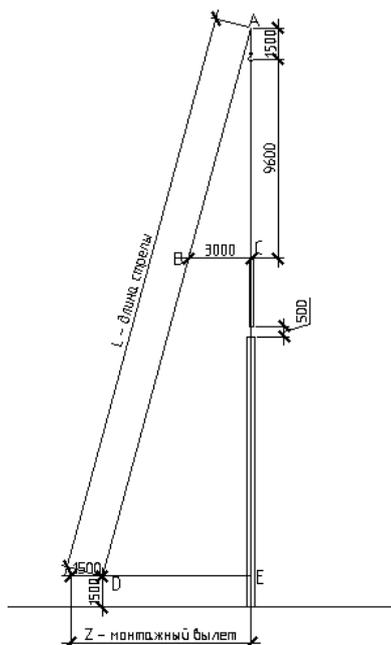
Схема к выбору крана для монтажа ферм покрытия
